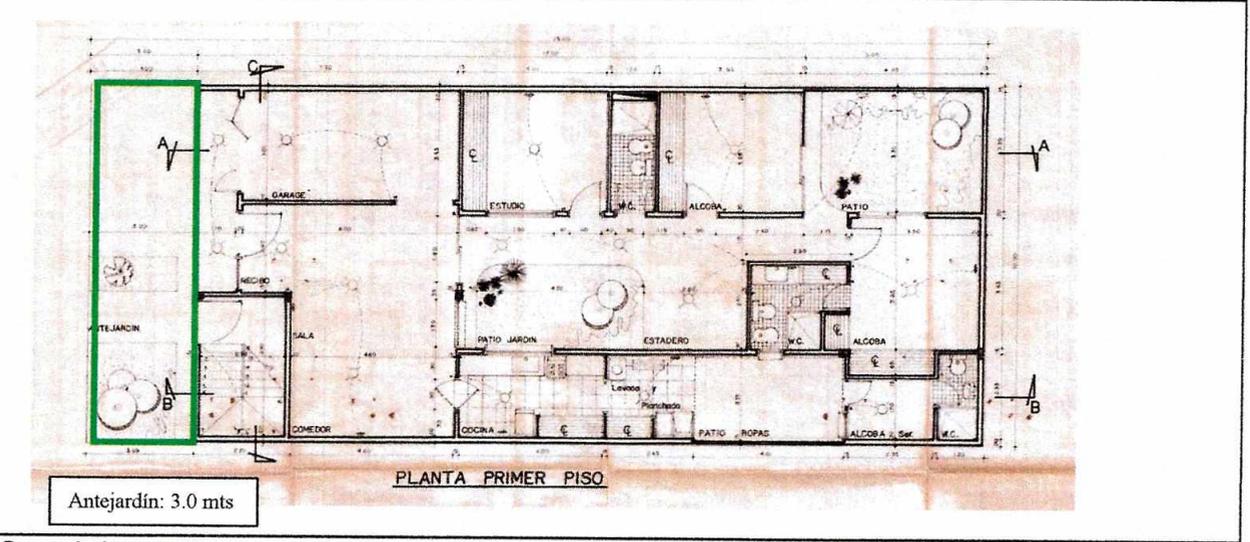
planos aprobados por la Secretaria de O.O.P.P.M.M sección control y Oficina del Plano Regulador Licencia de Construcción No. 334. Registro No. 134 de 13 de septiembre de 1973
